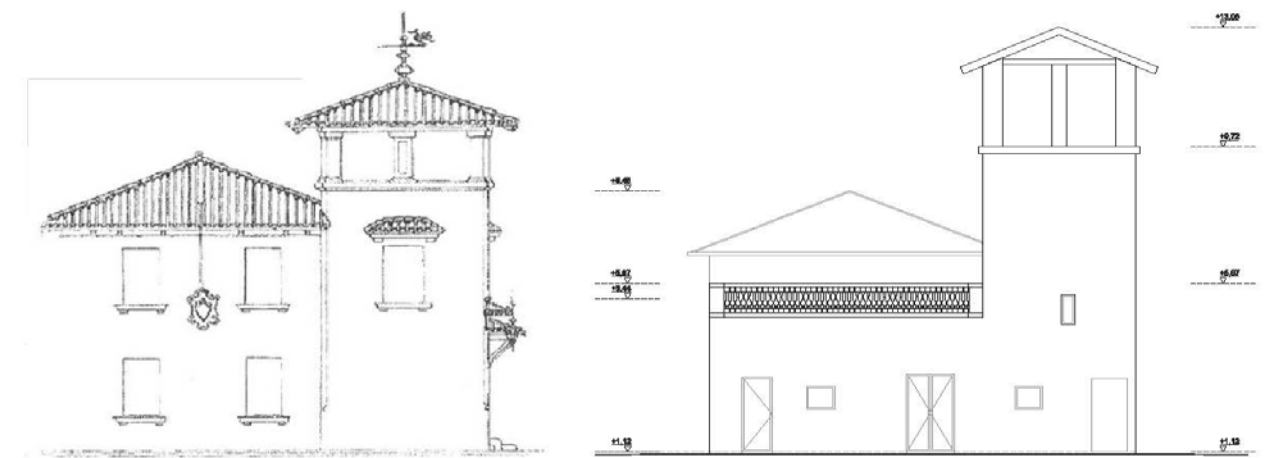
Fachada Norte. Comparativa del proyecto original con el estado actual.
